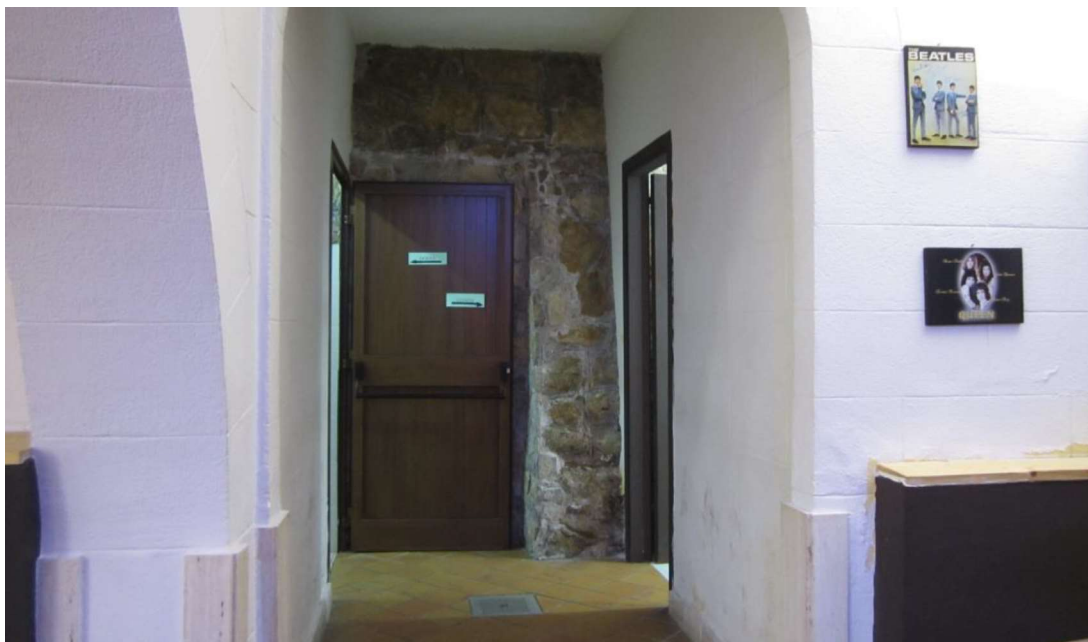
l'ingresso al blocco servizi del primo piano seminterrato
